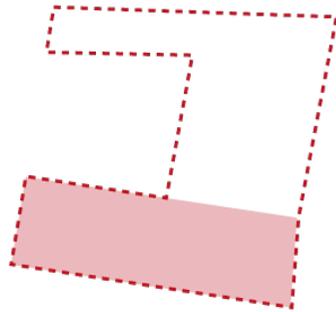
| Área de intervención manzana. Fuente: Elaboración Propia.
